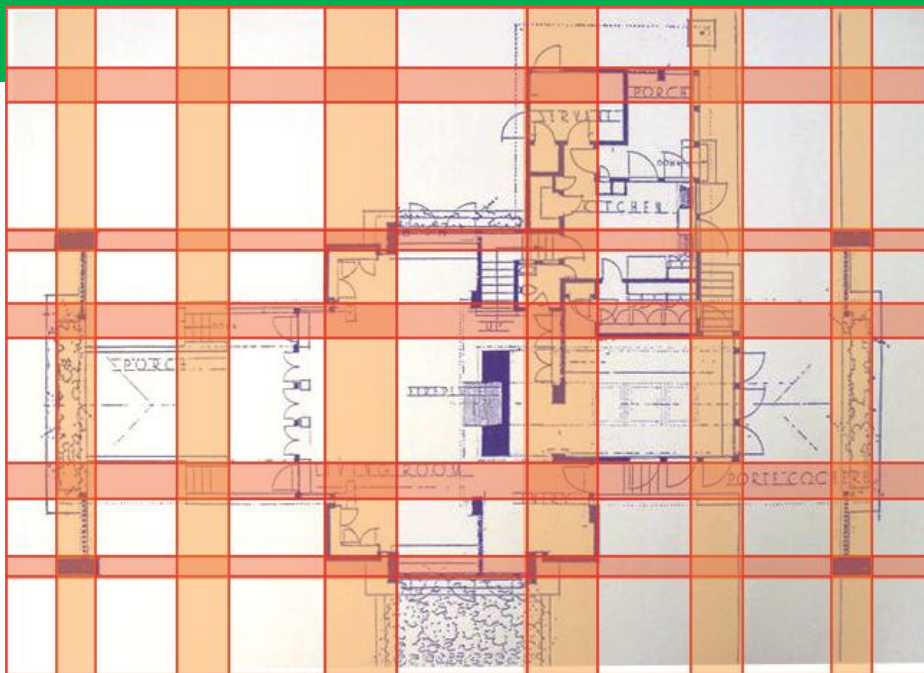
Planta baixa Casa Evans, Frank Lloyd Wright, 1908.
